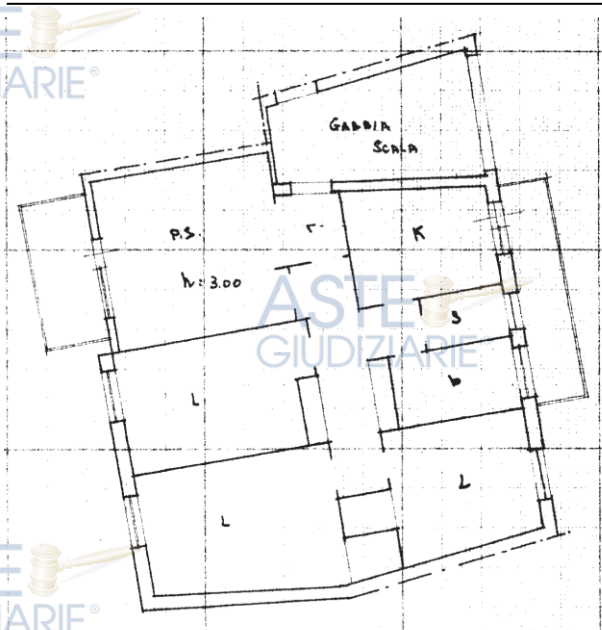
planimetria catastale dell'originaria edificazione dell'appartamento al piano rialzato
